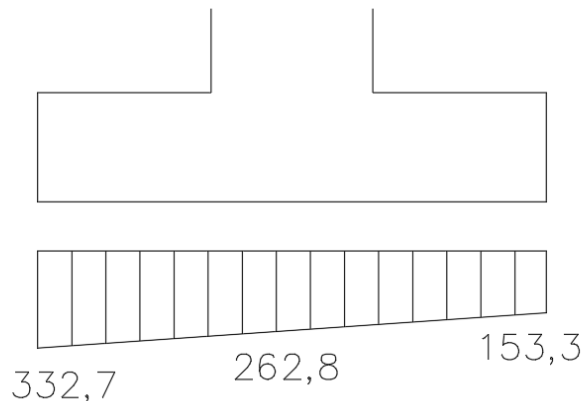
Эпюра давлений под подошвой фундамента
